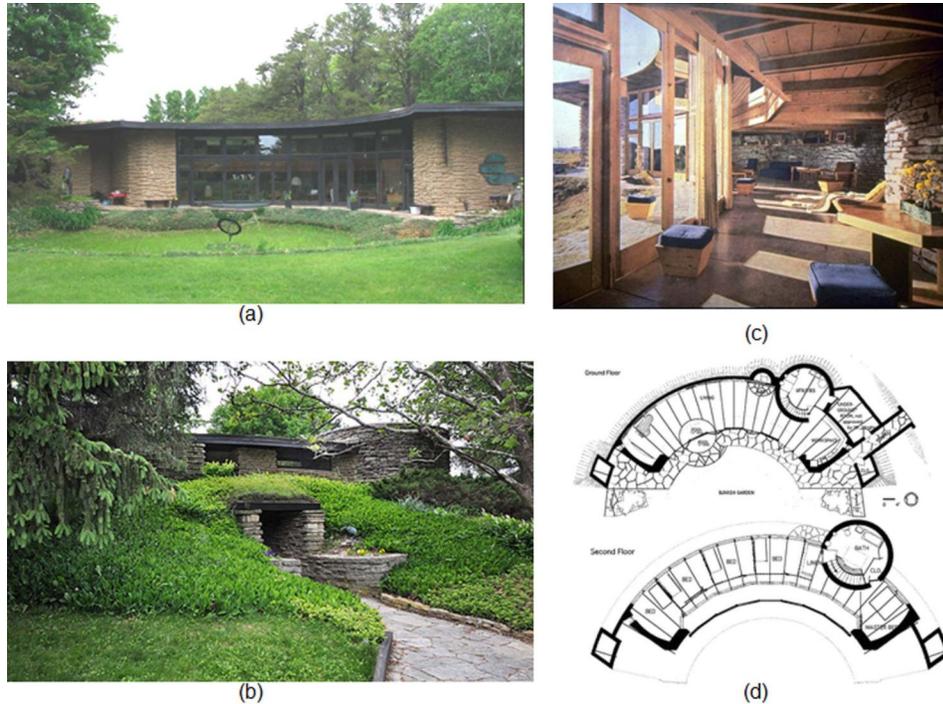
Frank Lloyd Wright, Casa Jacobs II, Wisconsin, E.U.A., (1948): (a) Vista exterior principal, (b) Vista exterior – Acceso principal, (c) Detalle interior – Sala de estar, (d) Plantas arquitectónicas.
